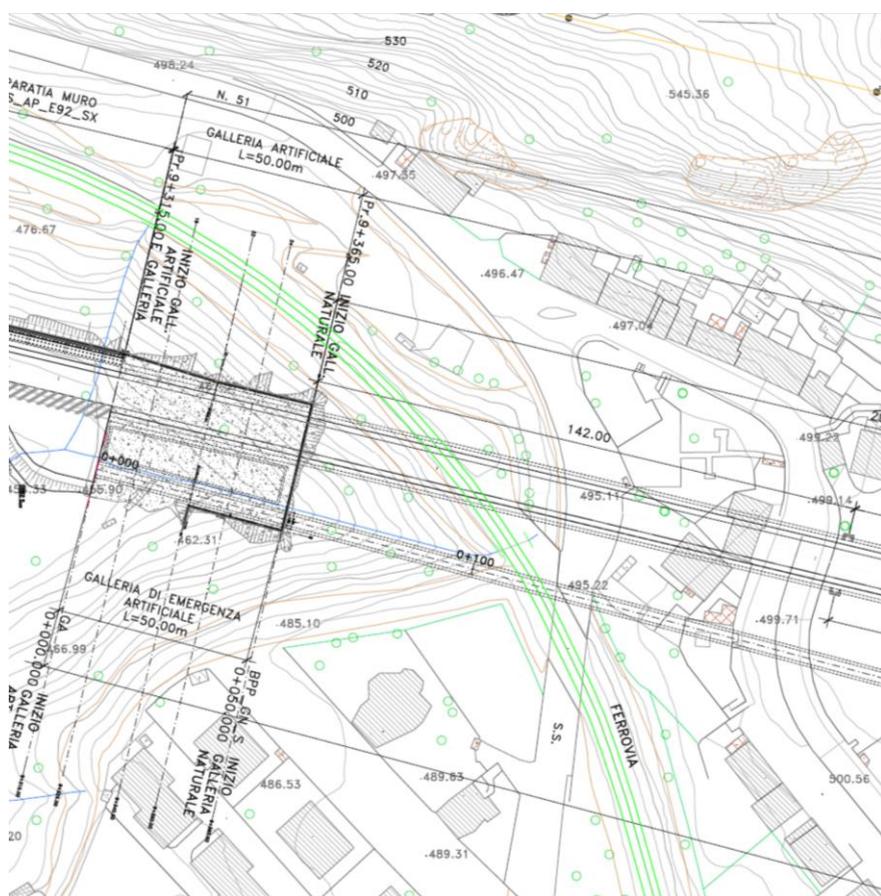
Planimetria Interferenza 1 e 2 SS51 – Tratta ferroviaria Ponte nella Alpi – Calazo.
